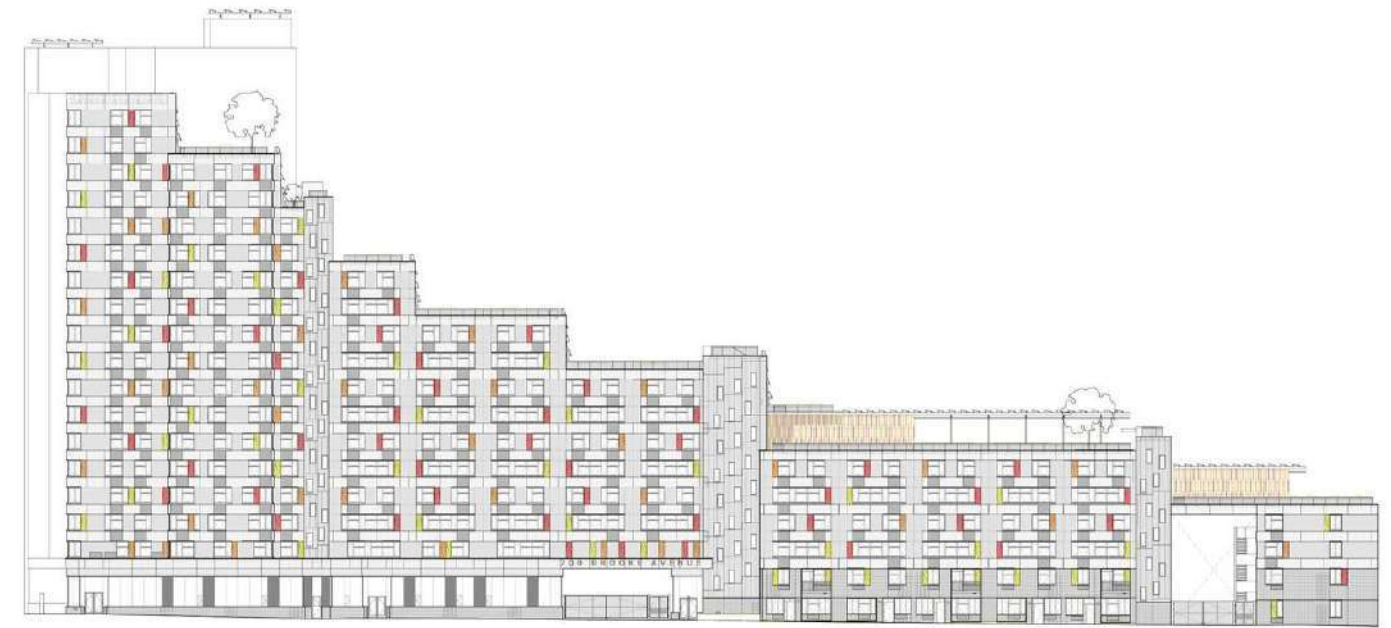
escalonamento - Fachada Edifício Via Verde. Fonte: <https://www.archdaily.com.br/br/01-181999/via-verde>.
